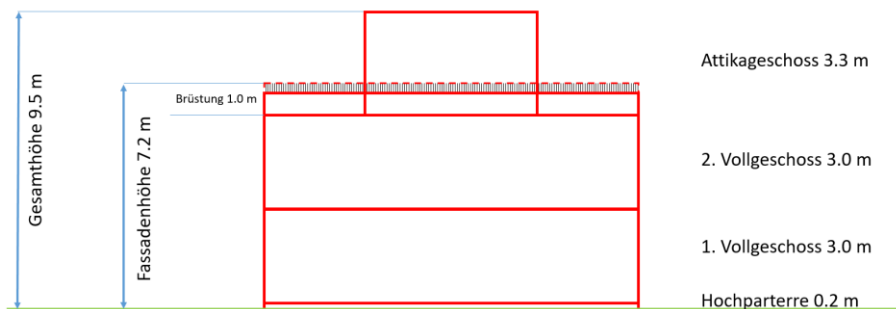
Flachdachbau W2 mit Attika in der Ebene mit neuen Höhenmassen
